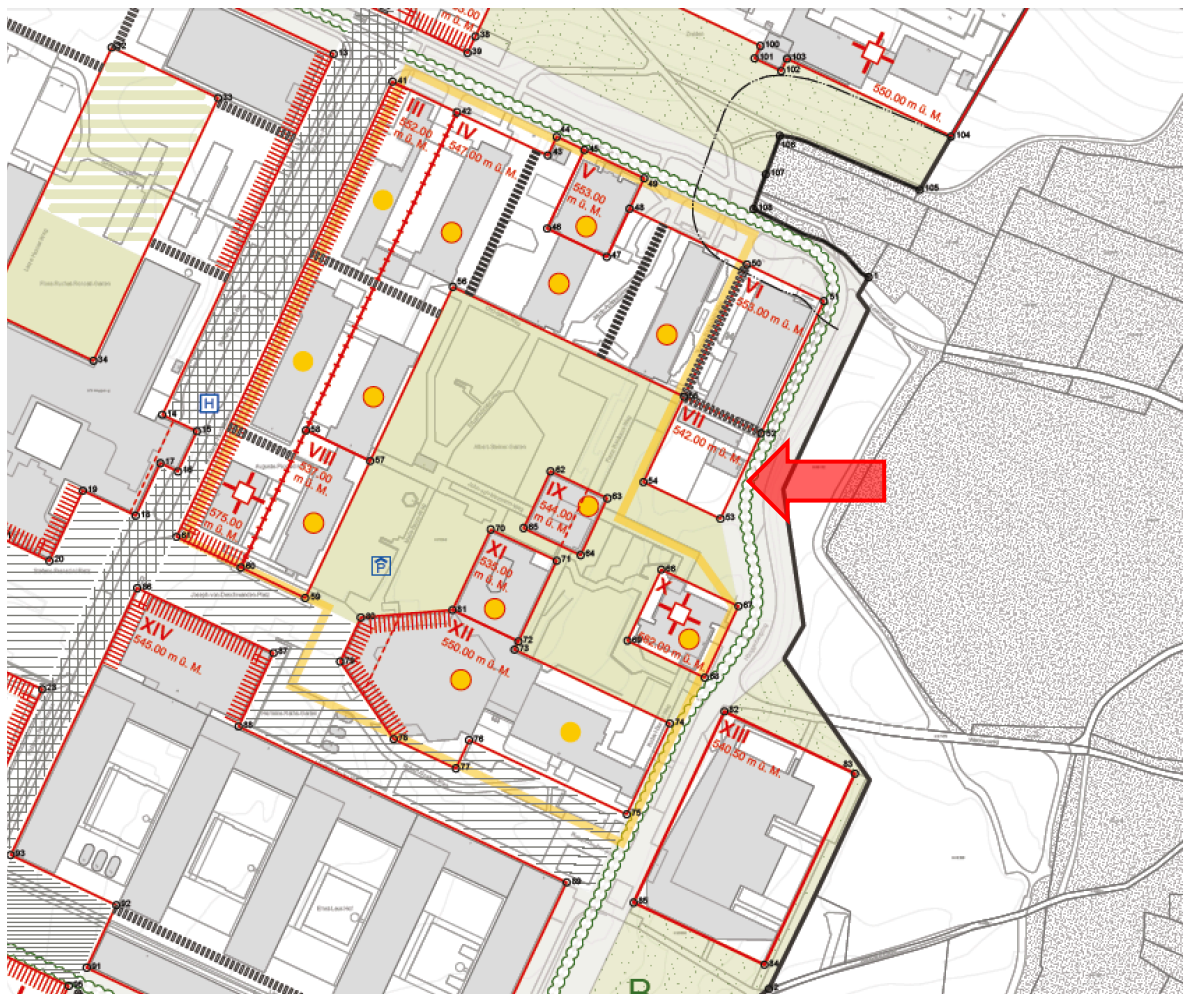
Ausschnitt Sondernutzungsplan mit Baubereichen
